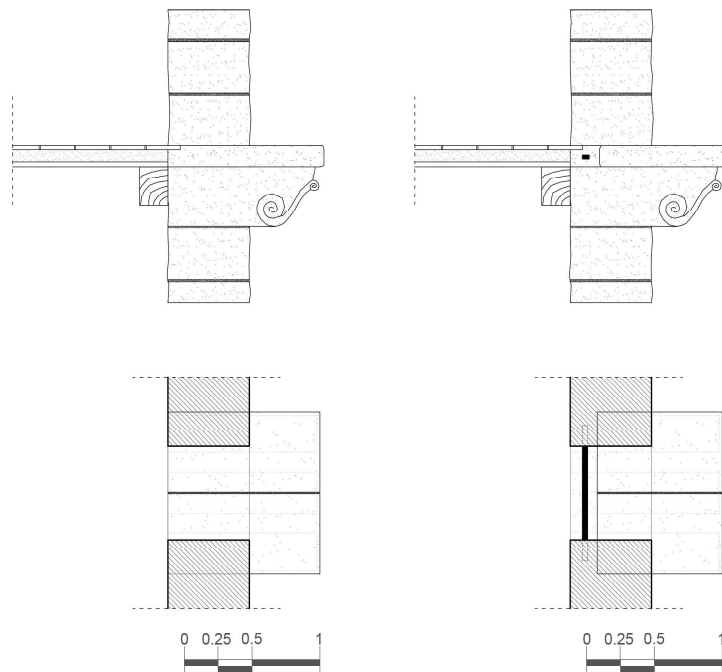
Deux types de balcons en pierre. A gauche, le balcon avec dalle en pierre jusqu’au fil intérieur du mur. A droite, le balcon avec *bardella
